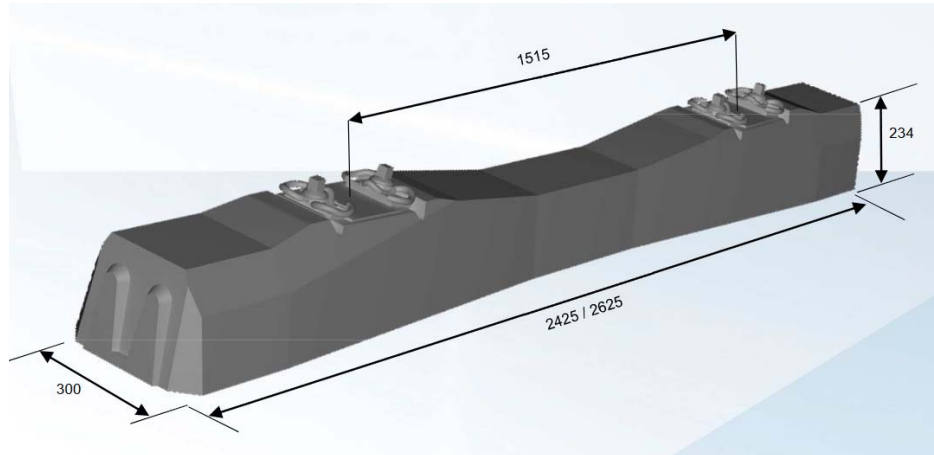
Spannbetonschwelle B70 (Railcon 2019)
